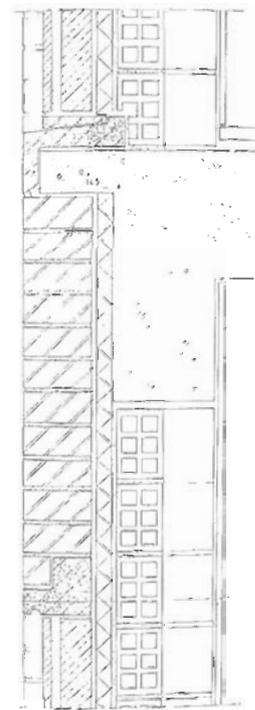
Detalle constructivo de la fachada y el apoyo en el forjado.
